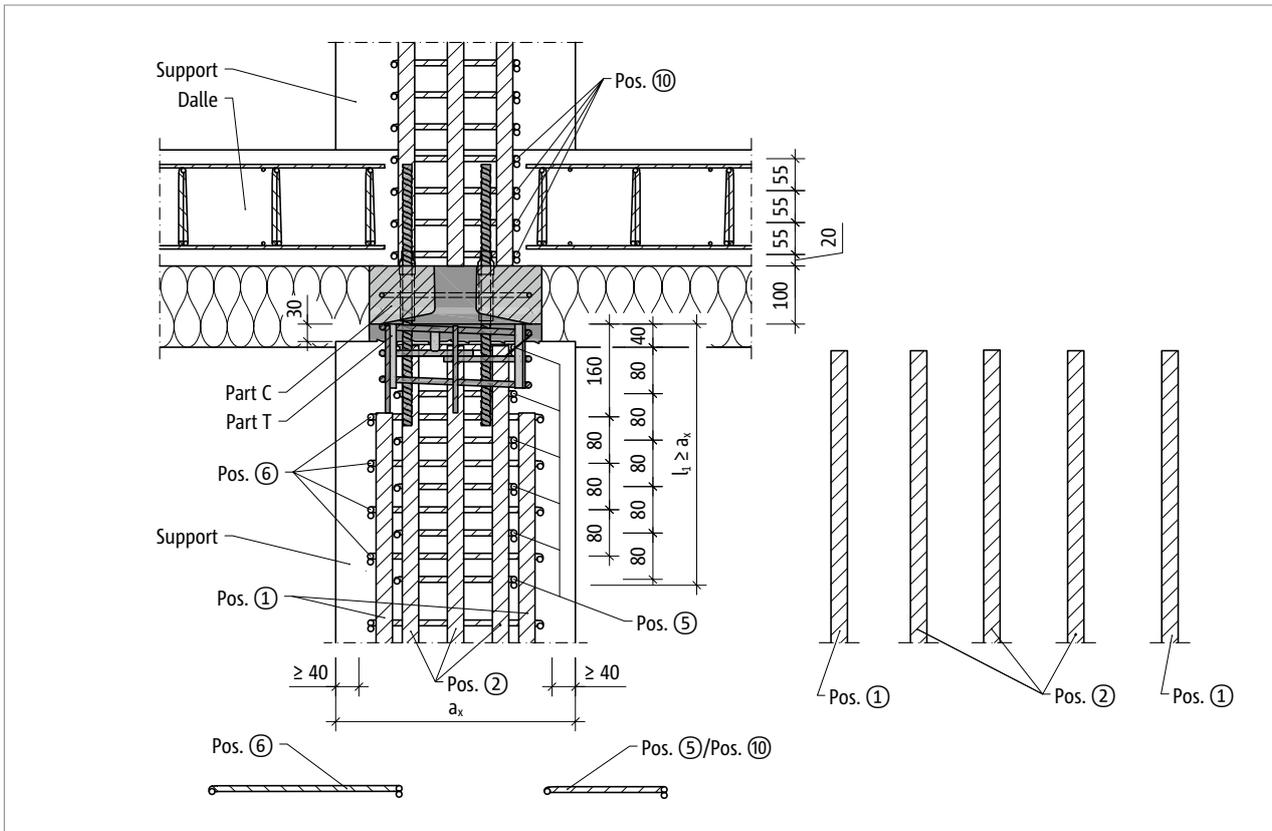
Schöck Scconnex® type P : renforcement sur site dans la coupe longitudinale A-A du poteau
